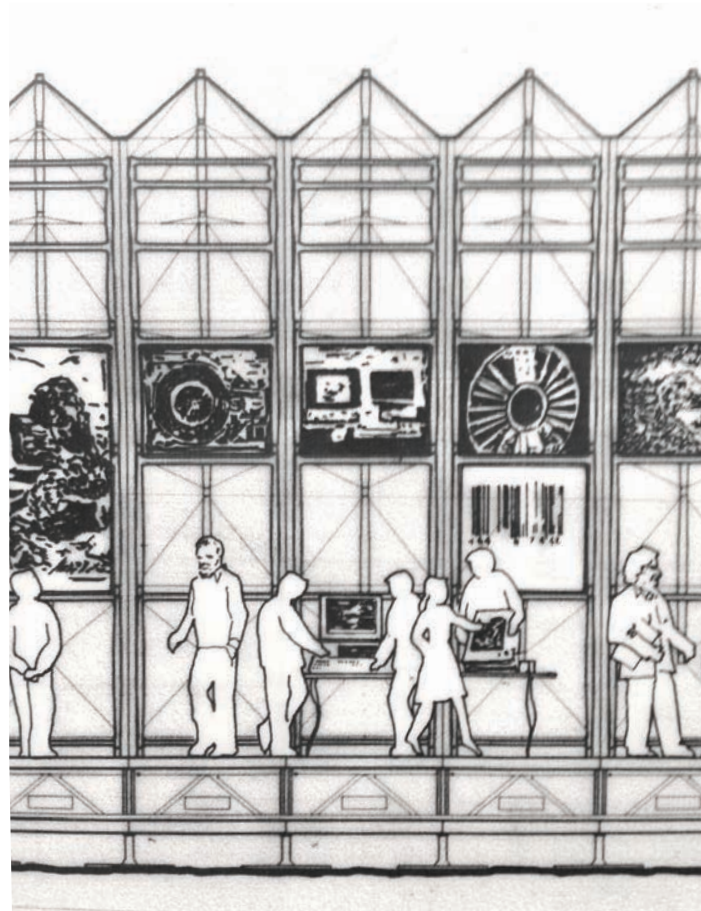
Desenho do Pavilhão IBM, 1982. Fonte: Fondazione Renzo Piano
